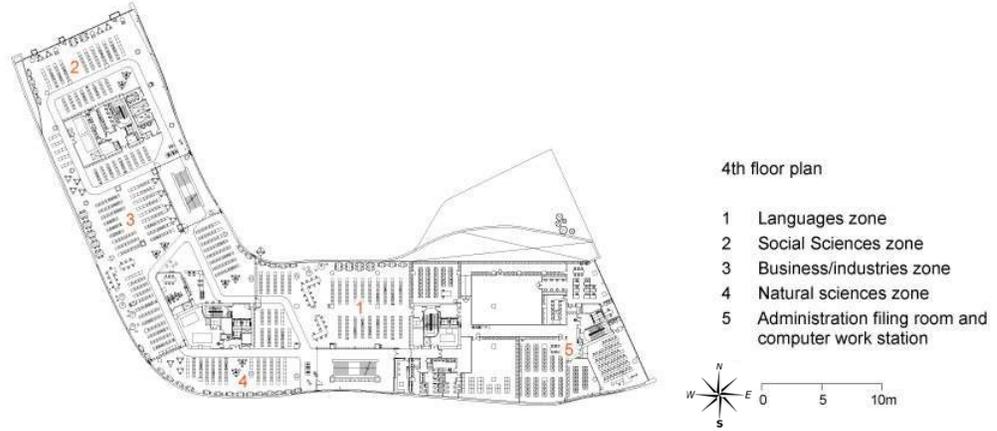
Layout Plan *National Library of Public Information Taichung
